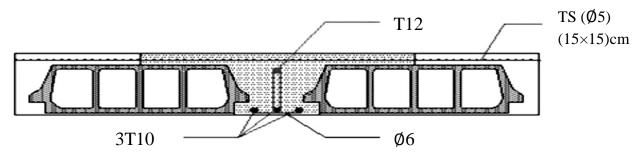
Coupe en travée d'étage courant (Type 01)
